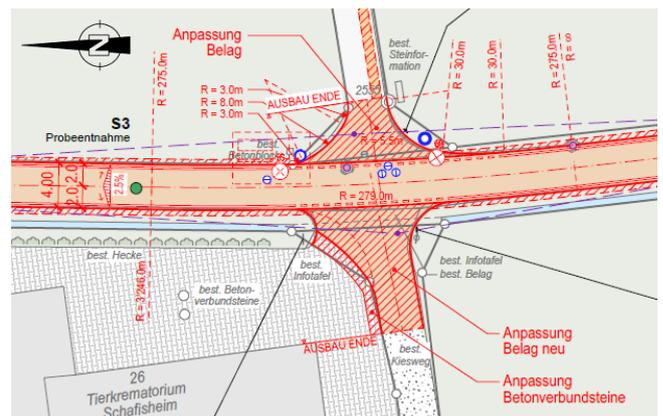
Planausschnitt aus dem Strassenbauplan Bereich Knoten Steinackerweg
